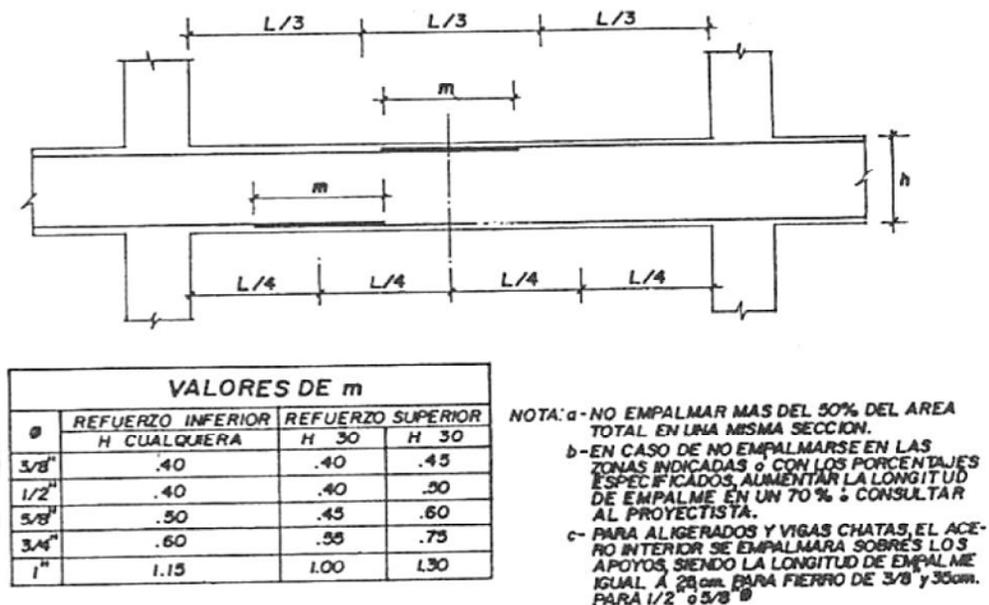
Consideraciones para Empalme del Refuerzo en Columnas (Blanco, 1994).
